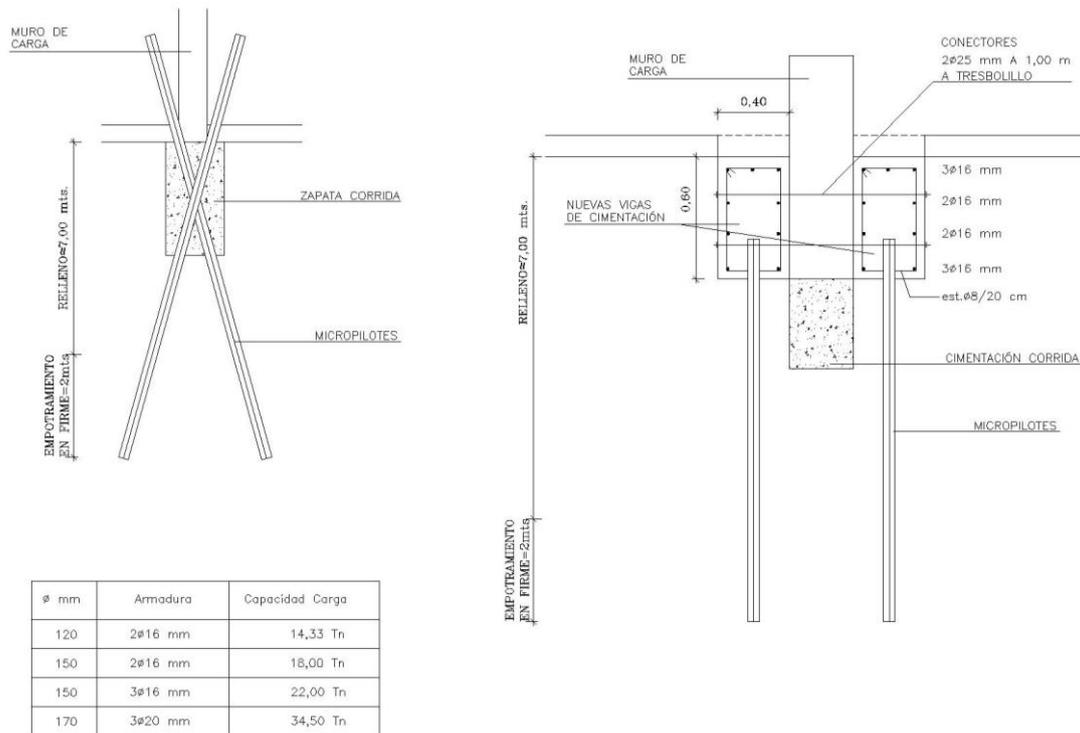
Refuerzo mediante inyecciones para mejora del terreno o micros armados. <https://epachon.wordpress.com/2013/01/08/e-1-recalce-de-cimentaciones-corridas-mediante-micropilotes/>
